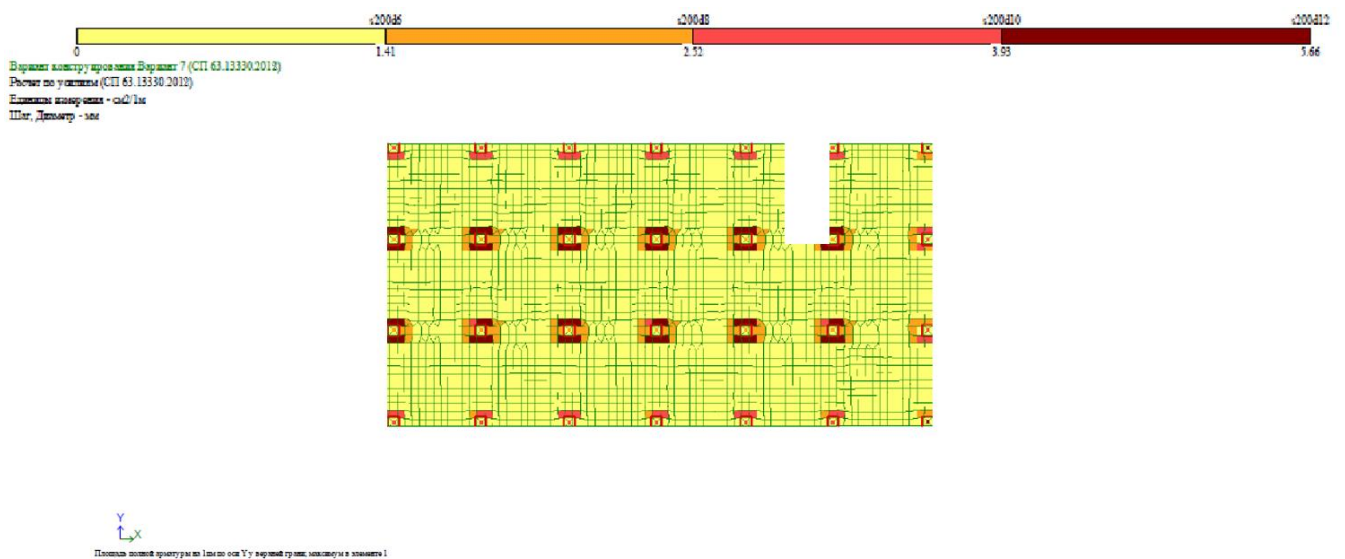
Подбор верхней поперечной арматуры плиты
